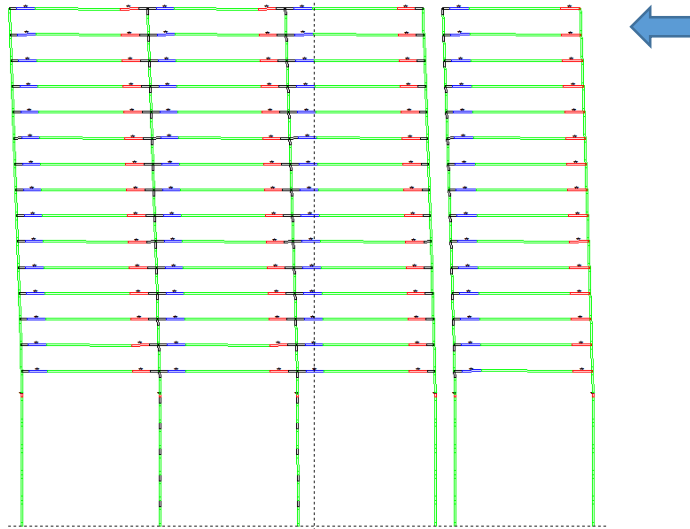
Estructura con todos sus elementos estructurales rotulados al máximo,  $T=21,1$  [s] (II).
